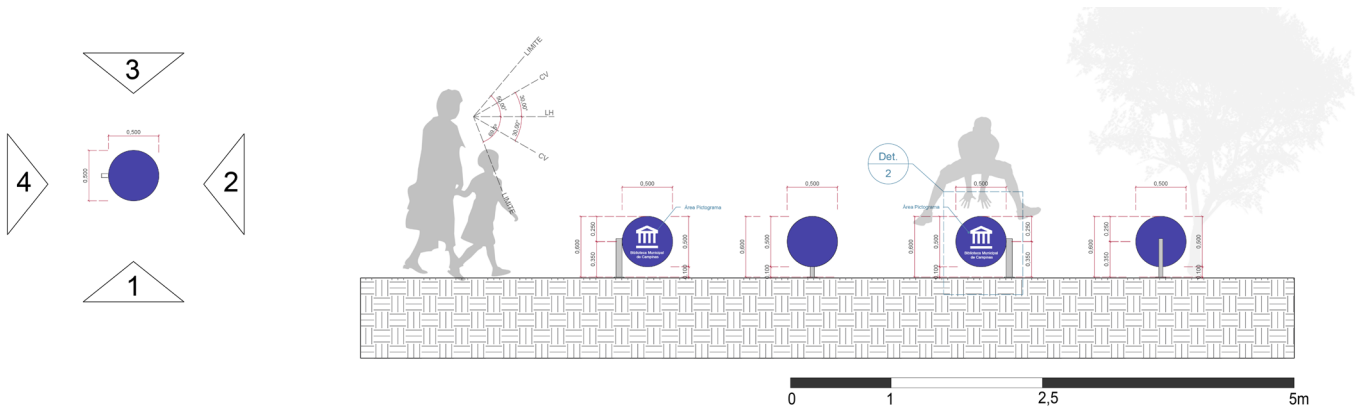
Vistas PIN baixo / Fonte: Autoria do grupo.
